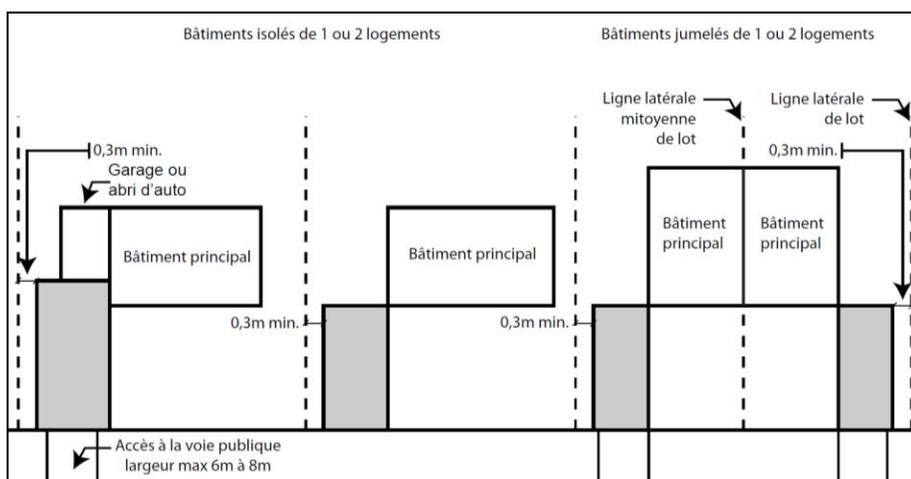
Exemple d’implantation d’une aire de stationnement avec empiètement devant la façade principale du bâtiment principal (modifié par le règlement R 2021-1122)
